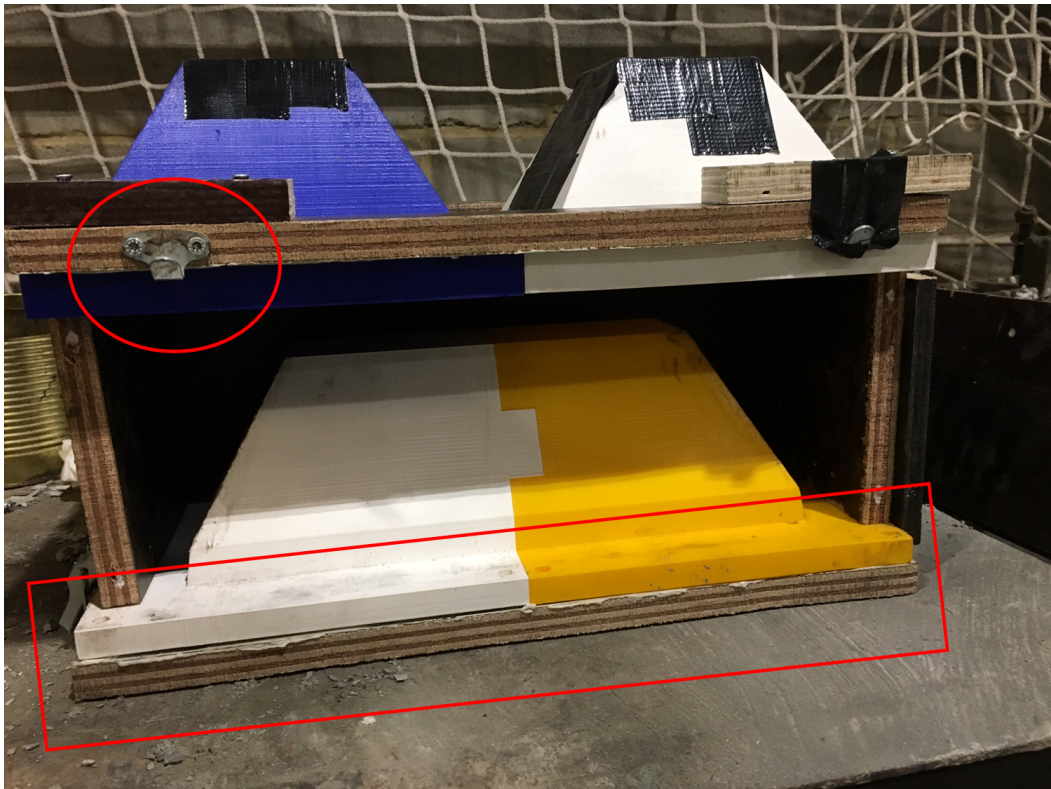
Moule équipé d'attaches type "boîte à outils" et de planches de renforcement
